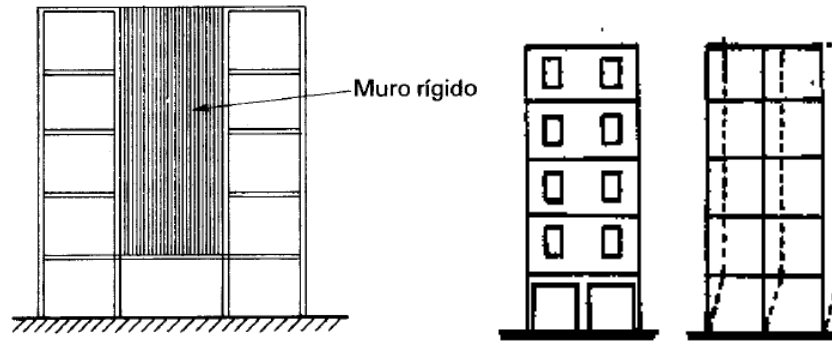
Edificio con planta baja flexible. La energía sísmica es disipada por deformación de las columnas de la planta baja, pudiendo conducir a un mecanismo de colapso (Sauter, 2004).
